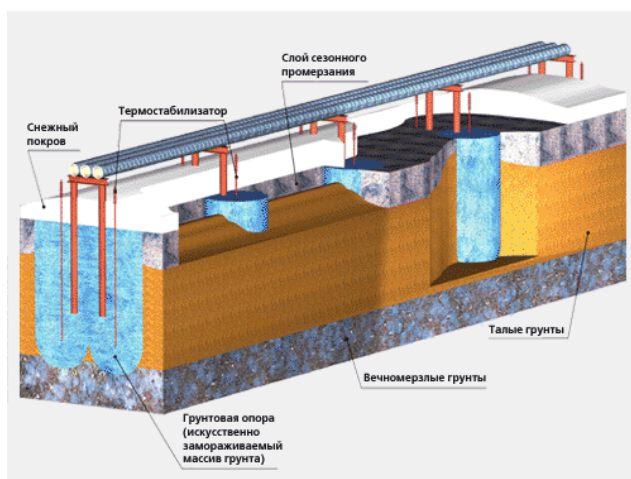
Усиление опор газопроводов надземной прокладки в районе распространения вечномерзлых грунтов несливающегося типа путем искусственного замораживания грунтов в основании
